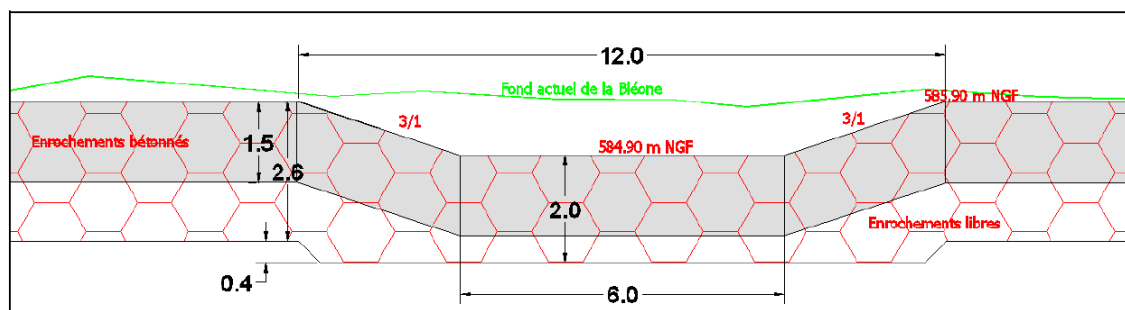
Profil en travers type de l'échancrure centrale du seuil du pont Beau de Rochas
